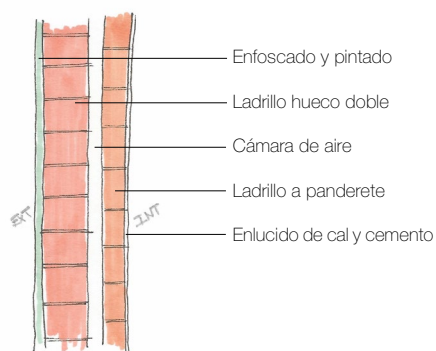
Detalle en sección de cerramiento fachadas, acabado enfoscado (autoría propia).
